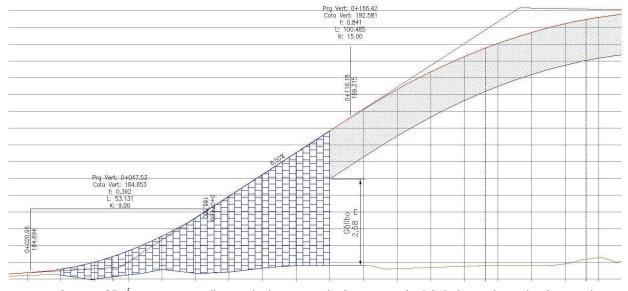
Área correspondiente a la tierra armada de un costado del viaducto, determinada entre la rasante del viaducto y el perfil del terreno, hasta obtener un gálibo de 2,50m.
